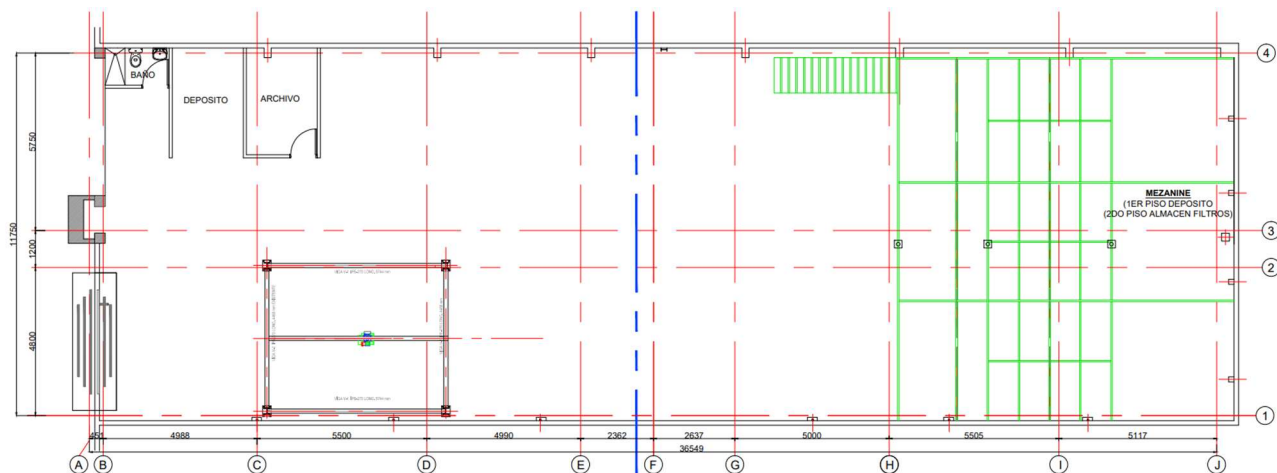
Plano Planta - Primer Piso Lado derecho. Fuente: Venfil Ingeniería SAS
